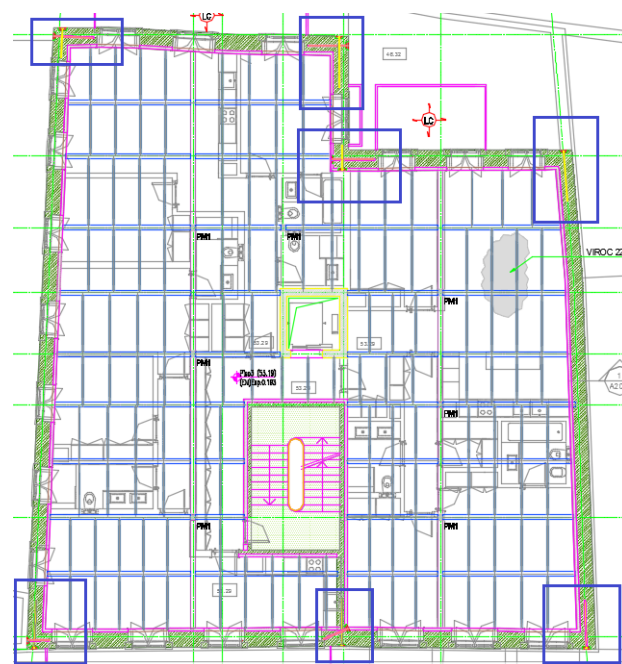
Indicação, em planta de piso tipo, dos locais onde se realizaram as pregagens
